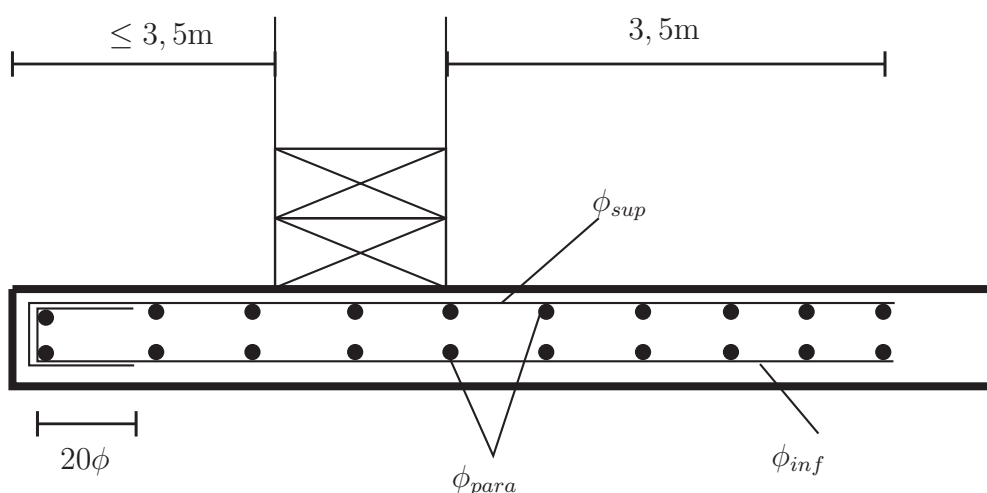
Esquema de armado de la platea en los muros “de borde”.
